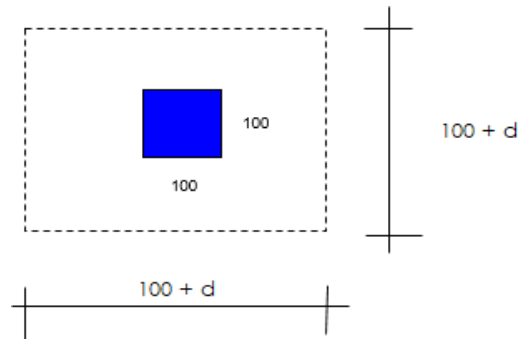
Columnas 8-9-10-11-14-15-16-17-20-21-22-23
